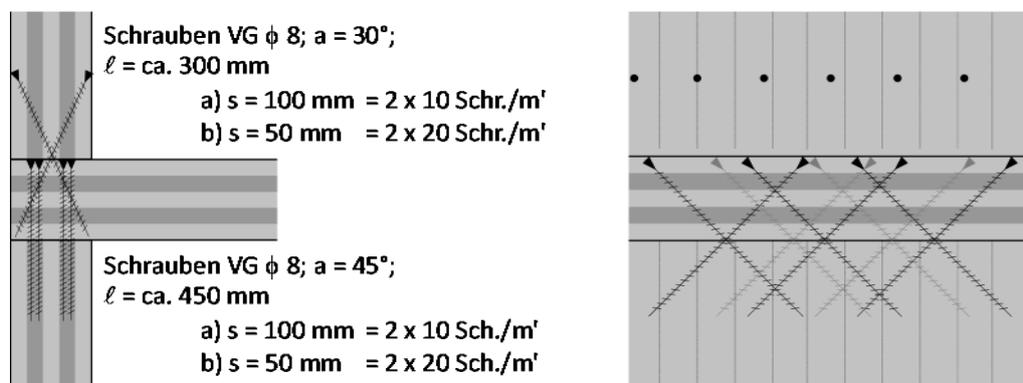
Assemblage avec vis à filetage continu, inclinées et disposé par couples
